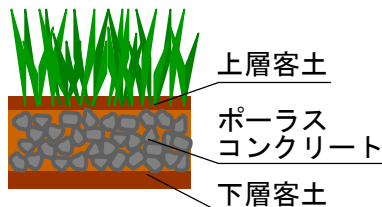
ポーラスコンクリートを用いた緑化基盤の断面例
